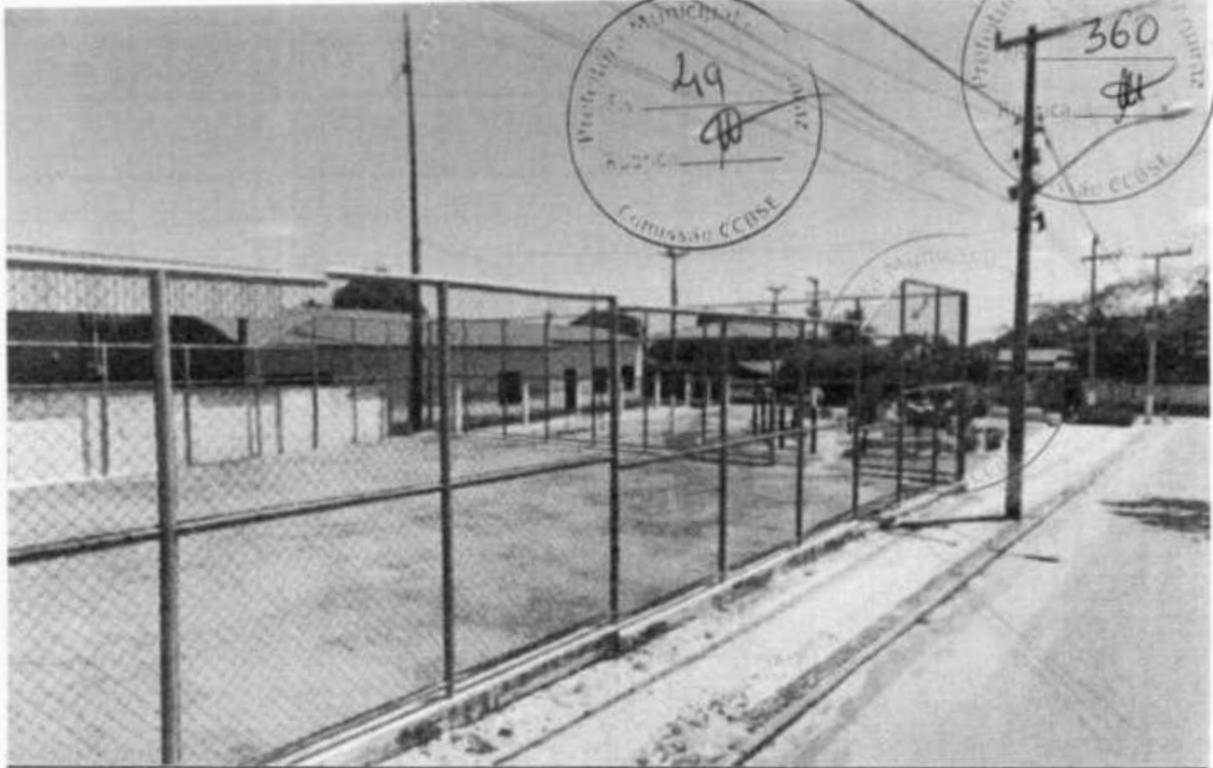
Vista lateral da praça do Jenipapeiro na rua Zé Cunha do Jenipapeiro
